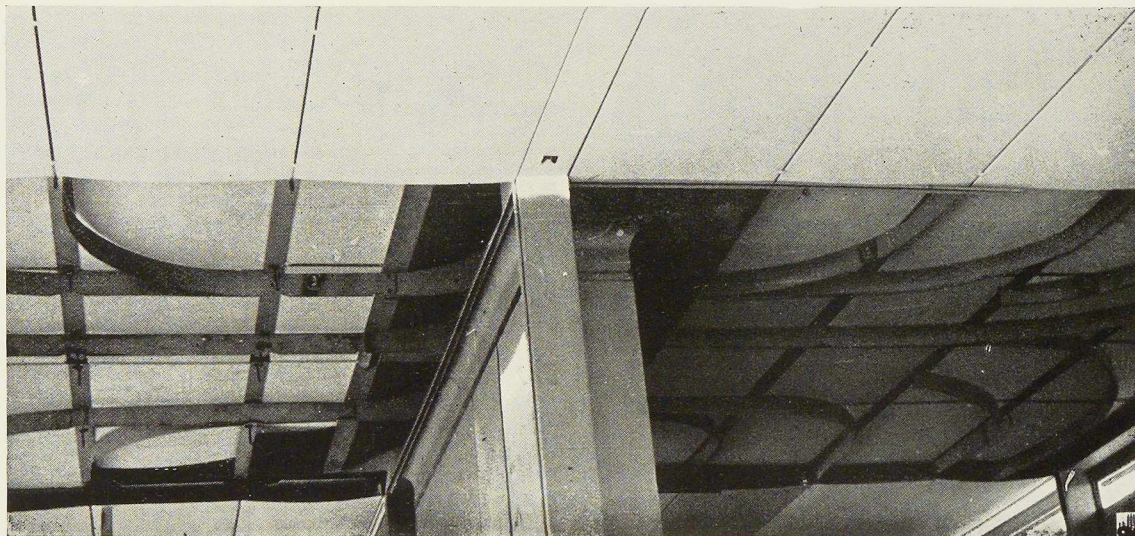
A l'arrière-plan et au premier plan, les plafonds chauffants mis en place. Au milieu, l'espace libre pour la circulation de l'air chaud et les déflecteurs en tôle le canalisant.
